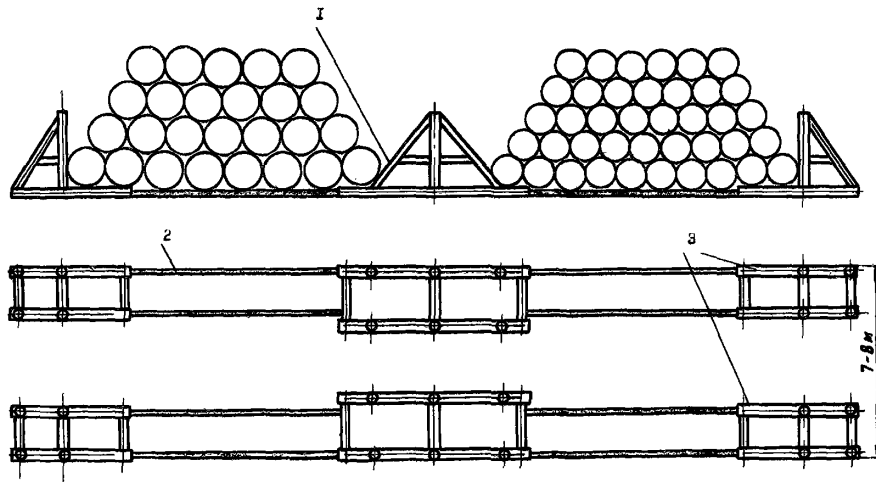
Схема штабеля труб разных диаметров с применением опорных разделительных стоек:
